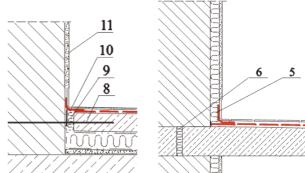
и 7. Гидроизоляция Hygrostop-Эластичным Армированным стыка стены со стяжкой террасы и стыка стены с плитой балкона: 5-Hygrostop Эластичный Армированный, 6-термическая прокладка, 8-арматура/анкер, который стабилизирует стяжку, 9-утепляющая прокладка, 10-Hygrostop-Эластичный Армированный, прикрытый плиткой, 11-штукатурка.
